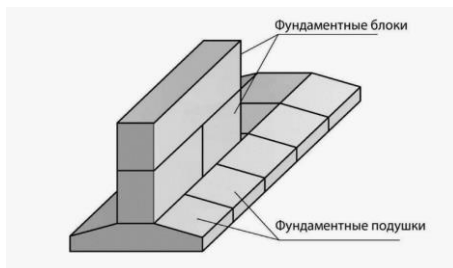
«Сборный ленточный фундамент из фундаментных блоков»
